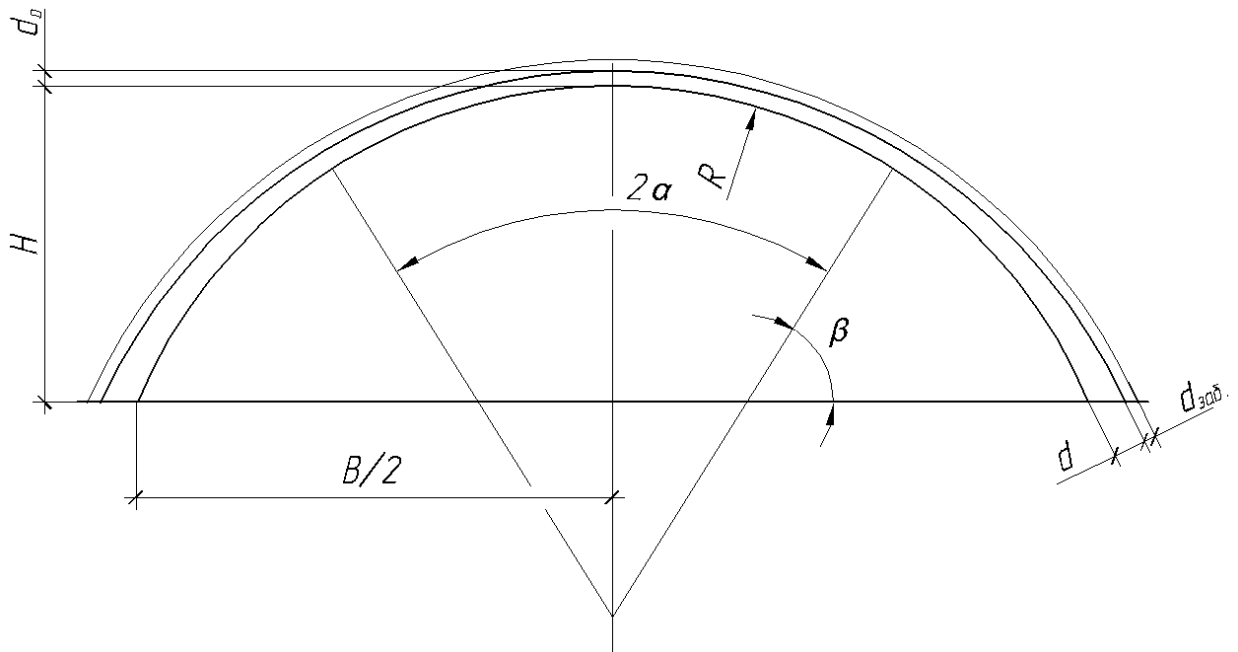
Схема до розрахунку навантаження на монолітне бетонне кріплення
